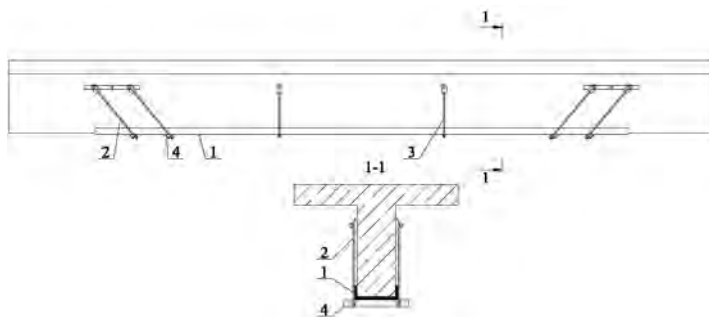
Усиление железобетонных балок металлом:
